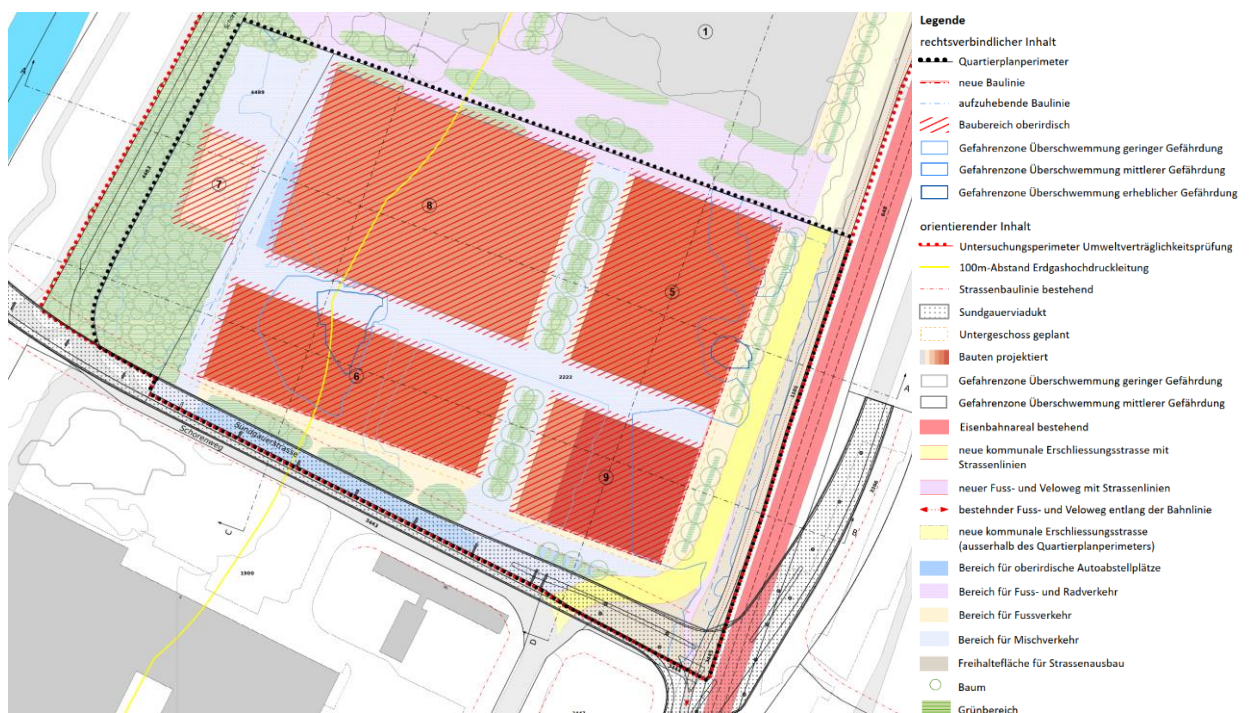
Ausschnitt Teilplan 1 Bebauung (Stand 15.02.2022, Jermann AG)
